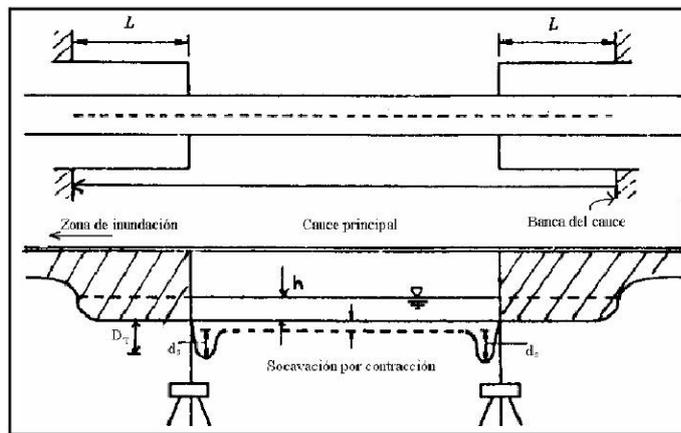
Estribos que se prolongan hasta el cauce principal y no existe flujo en la zona de inundación.
